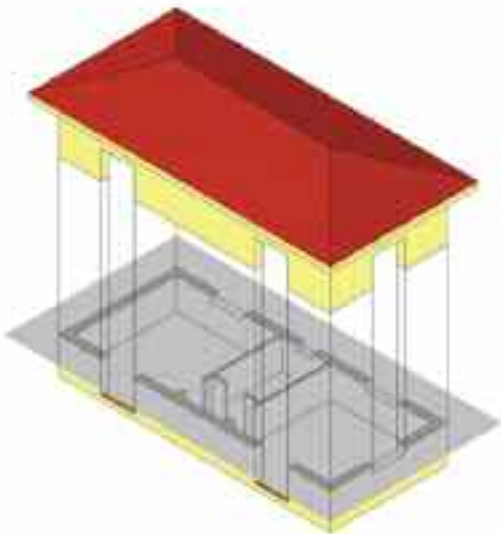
rimozione della parte dell'edificio sopra il piano di sezione
